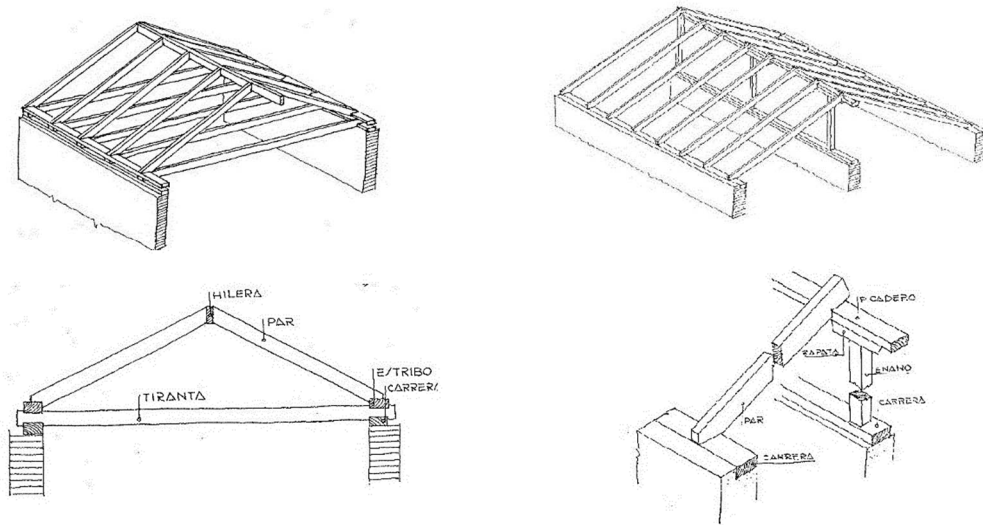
Cubiertas de “par e hilera” (izq.) y de “par y picadero” (der.)
